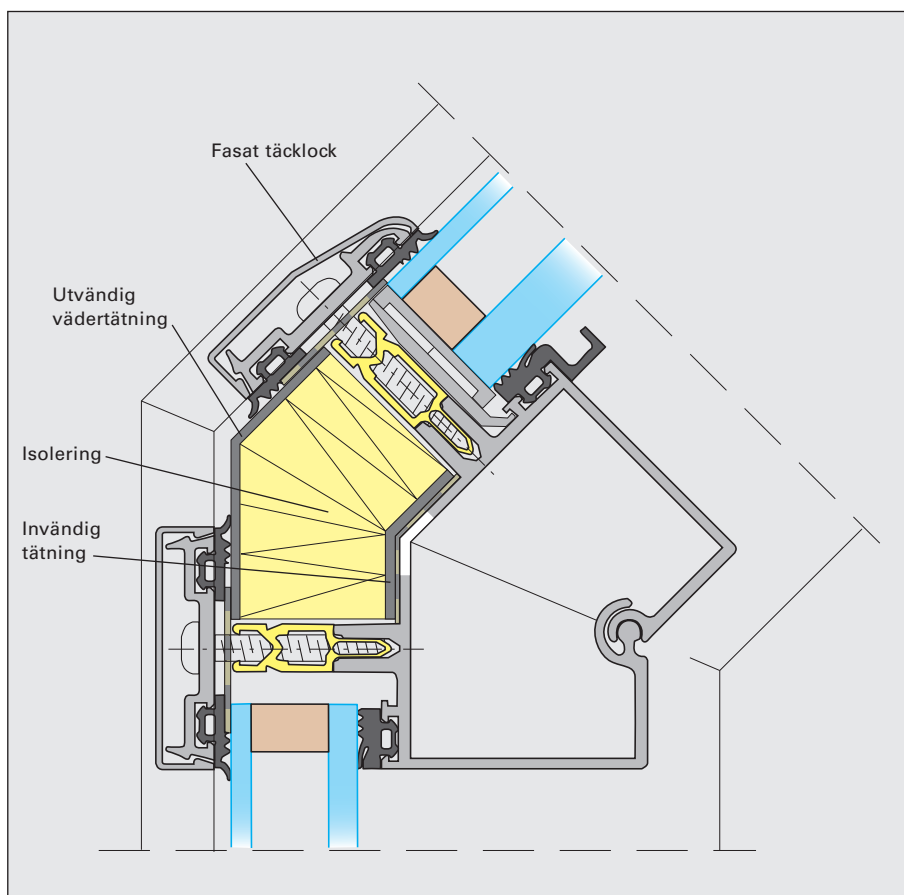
Övergång mellan glastak och fasad med prefabricerat hörnelement.
